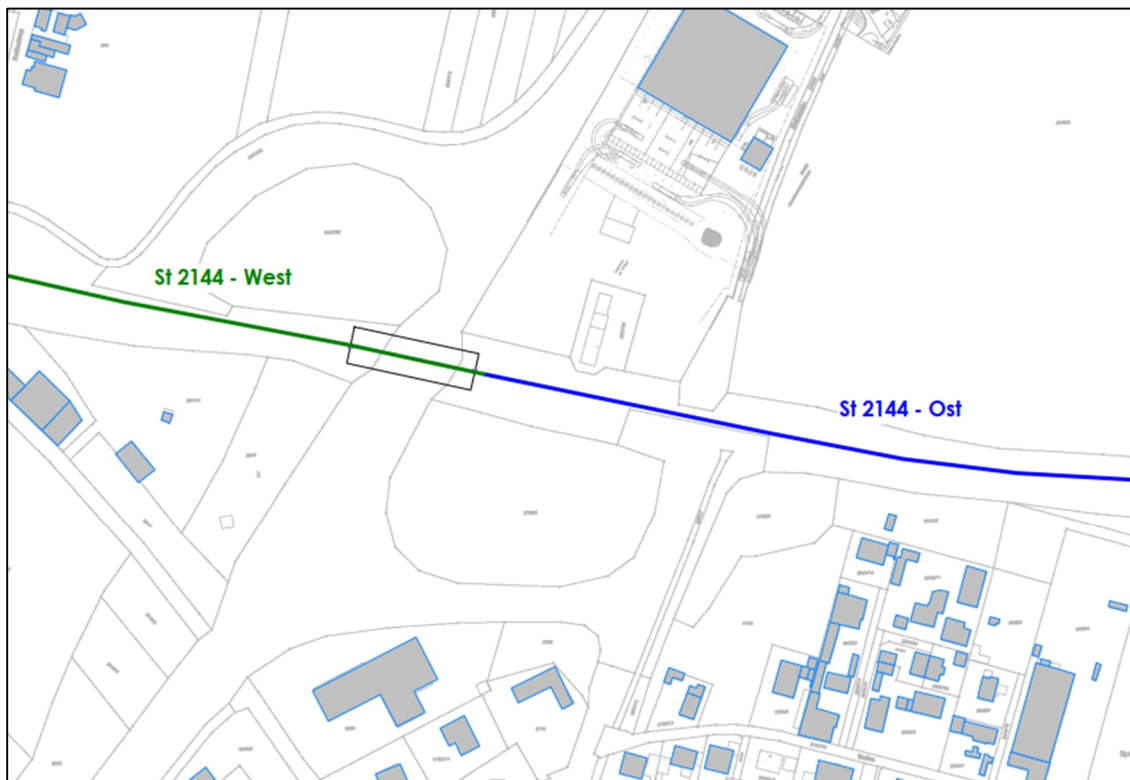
Lageplan mit Darstellung der betrachteten Straßenabschnitte für die Verkehrsprognose
